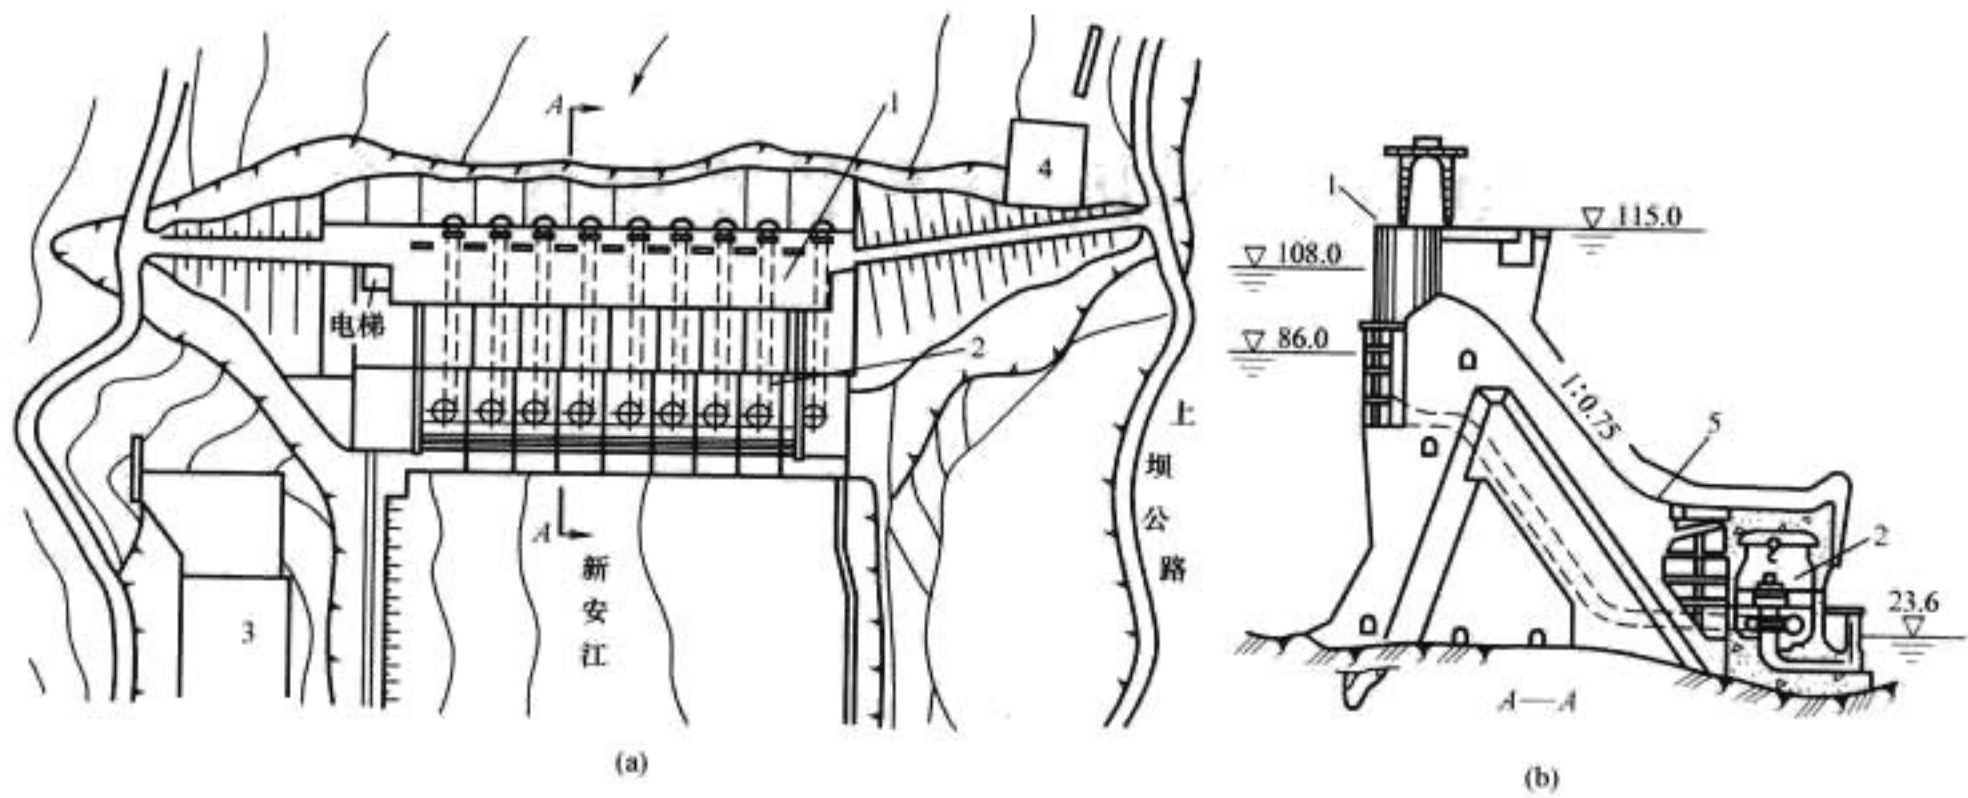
新安江水电站枢纽平面布置及溢流坝剖面图
